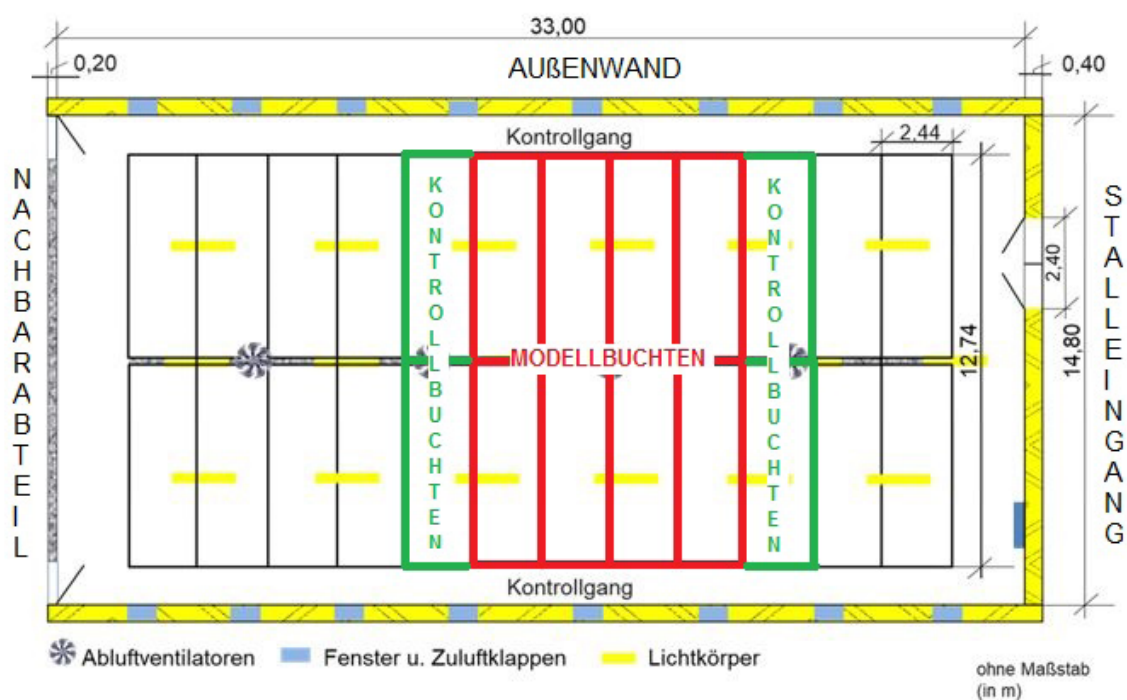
Grundriss des Mastabteiles mit den Modell- und Kontrollbuchten
